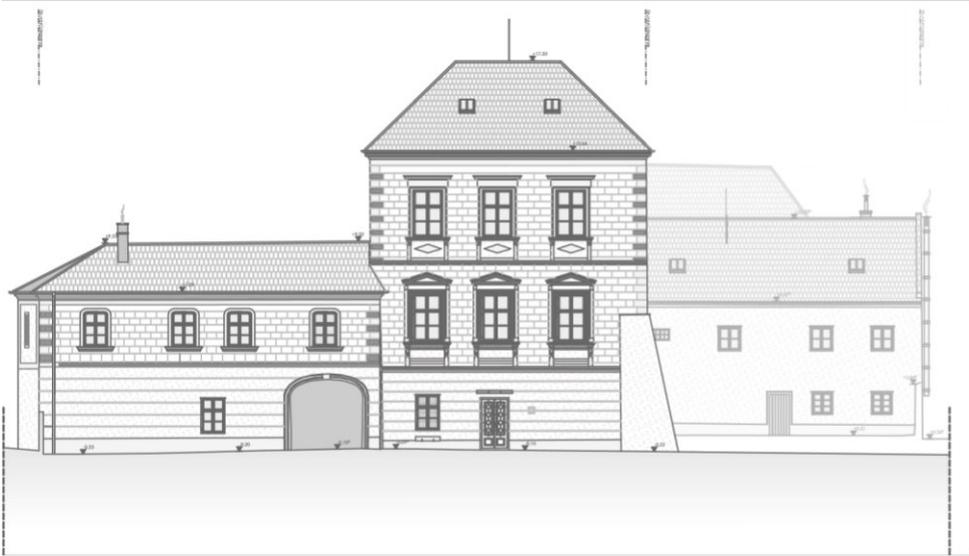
Bestandsplan Ansicht Nord- Übersichtsplan
